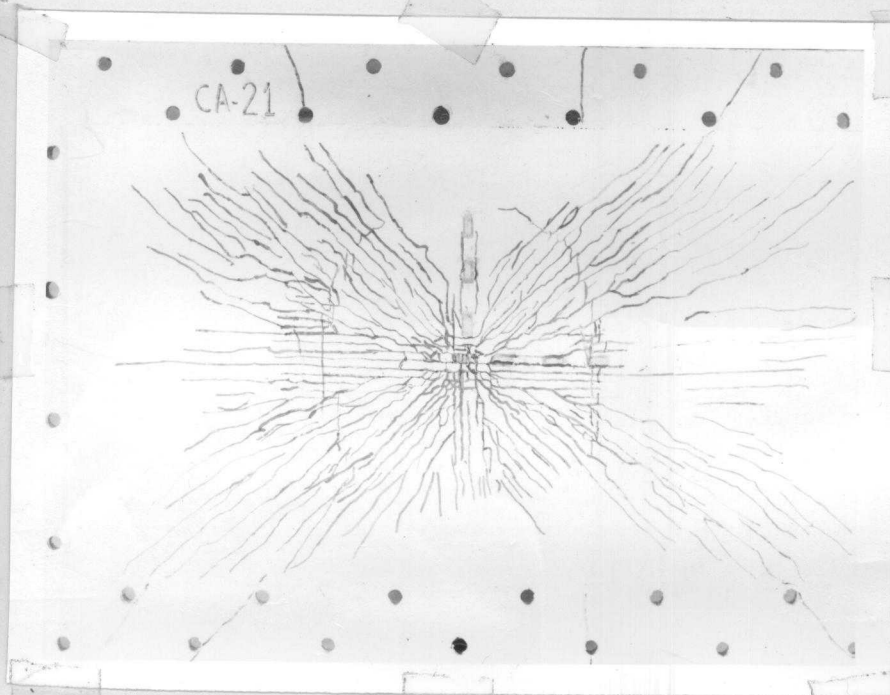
Configuração de ruína (face inferior) da Laje CA-21.
